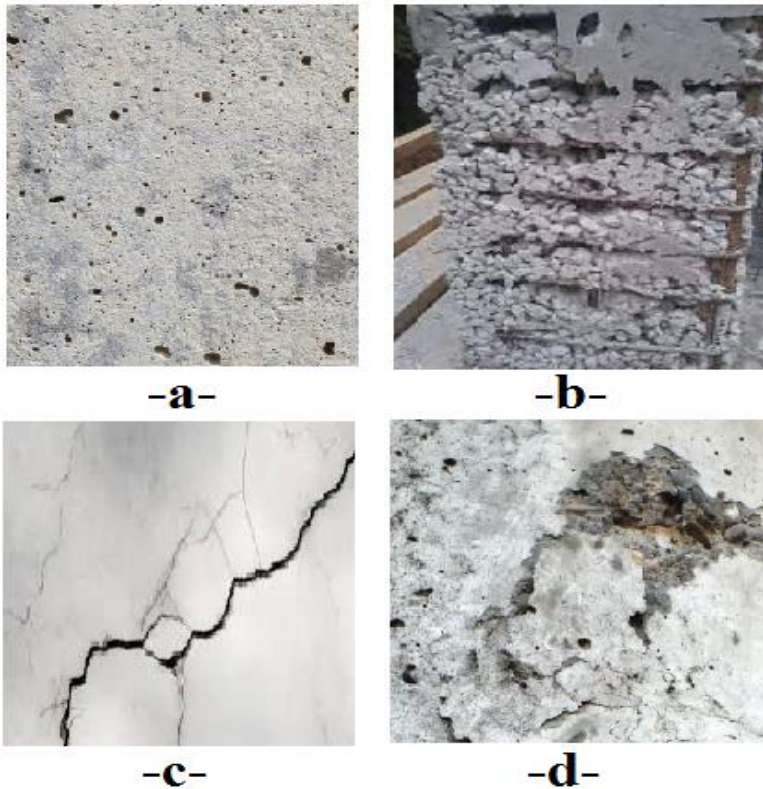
Exemples de dégradation de béton par : (a) mauvaise qualité du béton ; (b) ségrégation de béton ; (c) fissures dues à l'absence de la cure du béton (d) décollements du béton au-dessus d'une armature corrodée.
